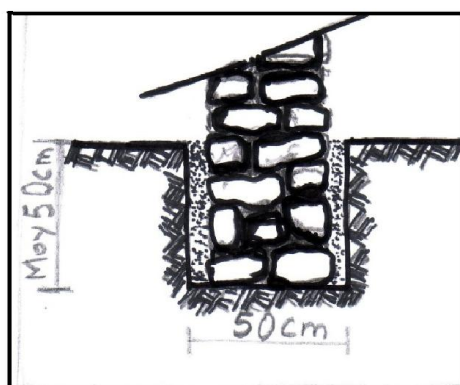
Coupe d'une fouille et fondation de mur en pierres hourdées
